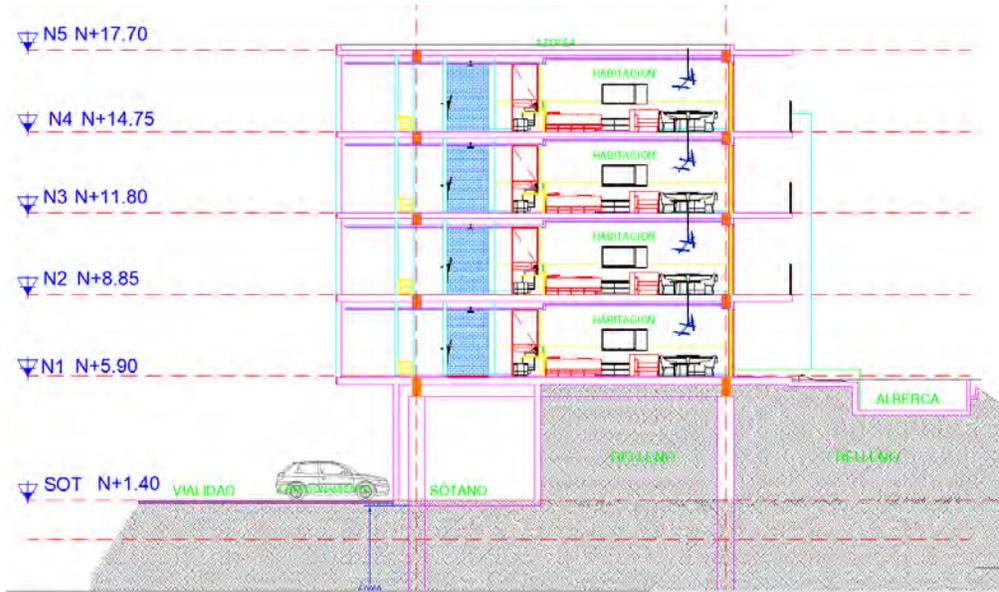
Vista de la altura de las edificaciones del proyecto.
